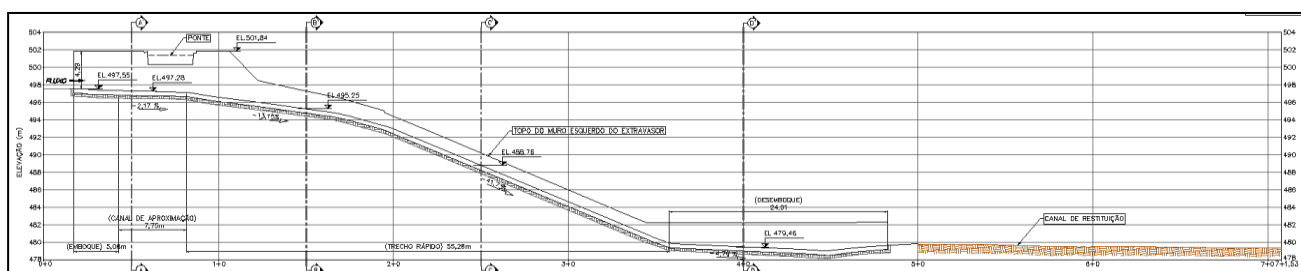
Sistema extravasor da Barragem Estéril Sul – Vista em perfil.
